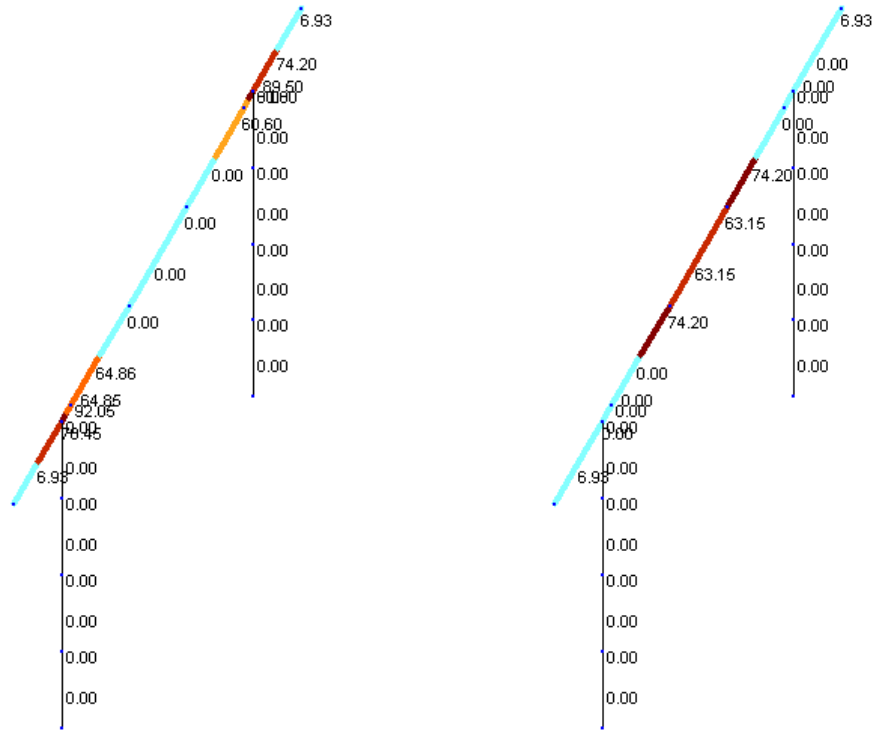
Сумарна площа верхнього і нижнього пояса арматури ригеля опори № 3
